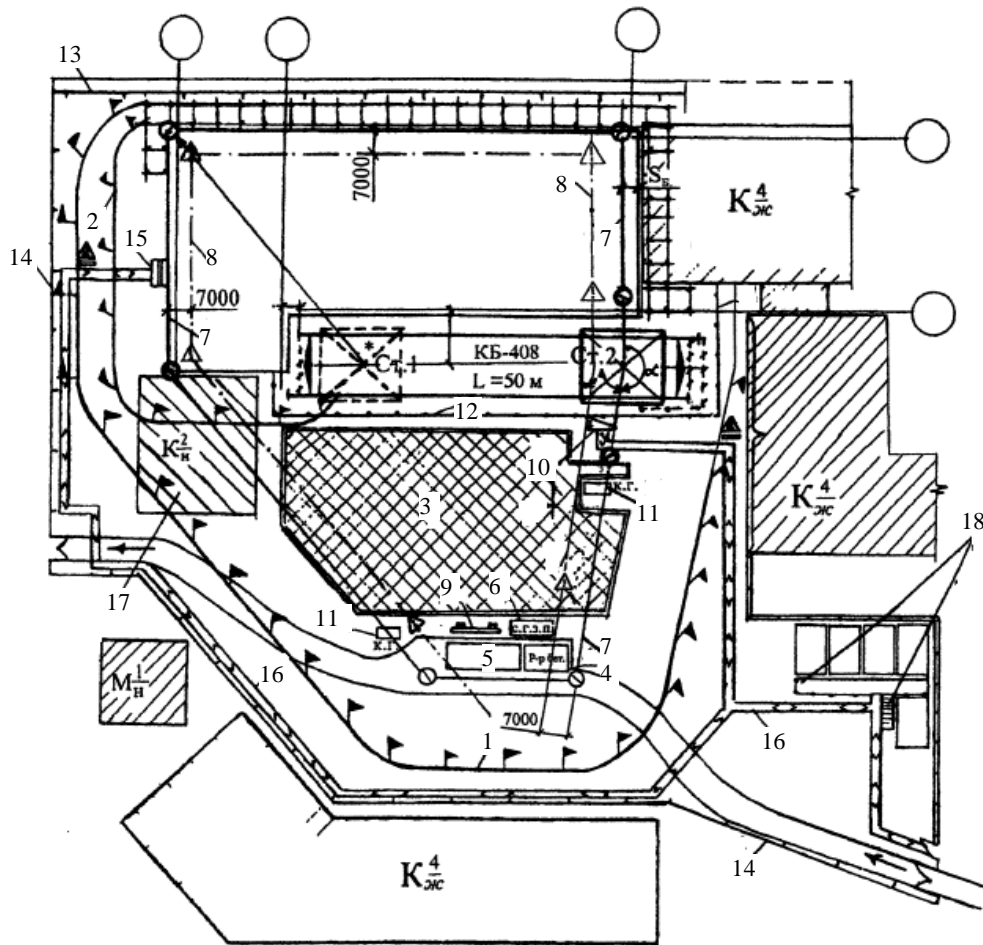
Організація будівельного майданчика: 1 – межа небезпечної зони дії крана; 2 – те саме будованої будівлі; 3 – зона складування вантажів; 4 – майданчик приймання розчину та бетонної суміші; 5 – стоянка транспорту під розвантаженням; 6 – місце зберігання вантажозахватних пристроїв і тари; 7 – межа зони обслуговування; 8 – лінія попередження межи зони обслуговування; 9 – стенд схеми стропування; 10 – шафа електроживлення; 11 – контрольний вантаж; 12 – огорожа кранової колії; 13 – тимчасова огорожа з козирком; 14 - тимчасова огорожа; 15 – навіс над входом в будівлю; 16 – доріжка пішохідна; 17 – відселена промислова будівля; 18 – місток із драбиною обслуговування другого яруса побутових приміщень
